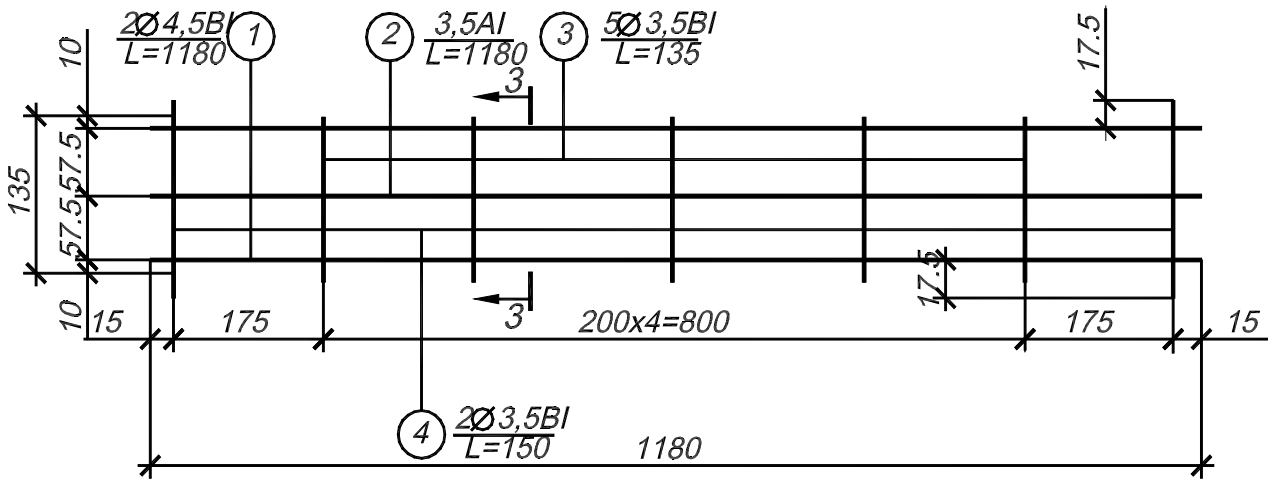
Варианты 11, 12, 13, 14, 15 задания «Железобетонные конструкции». Перемычка брусковая Б-12
